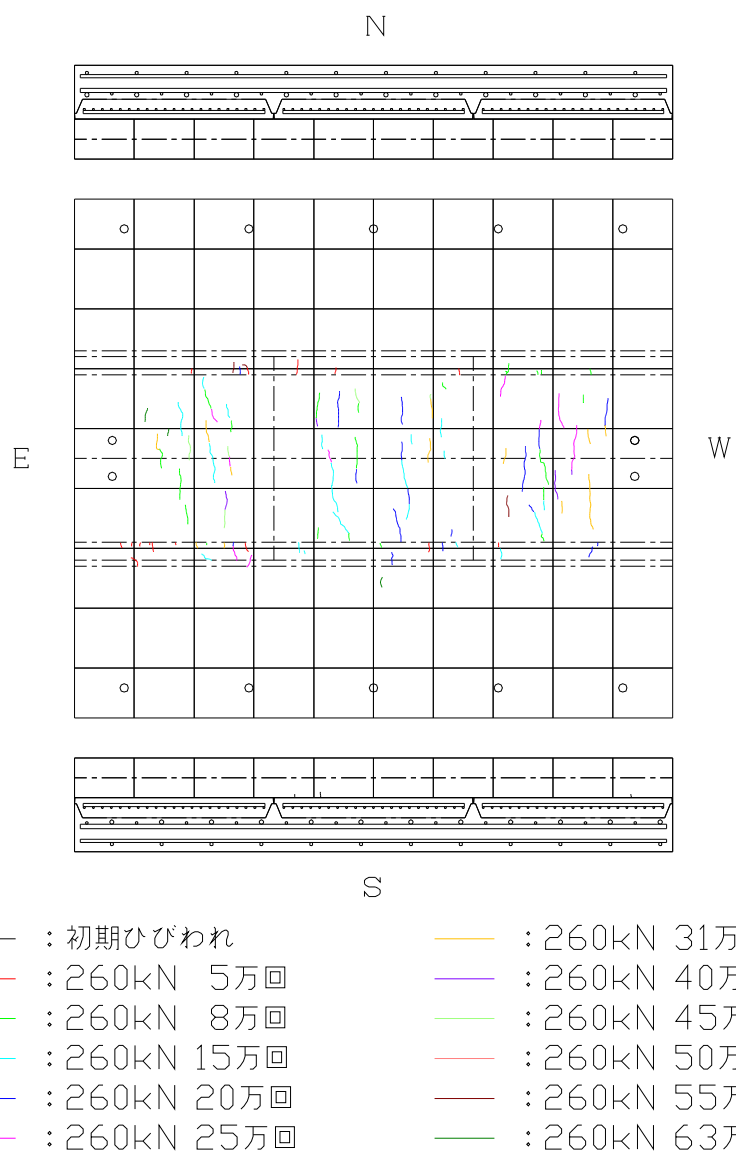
コンクリート下面および主桁上フランジ切欠部下面のひび割れ図
